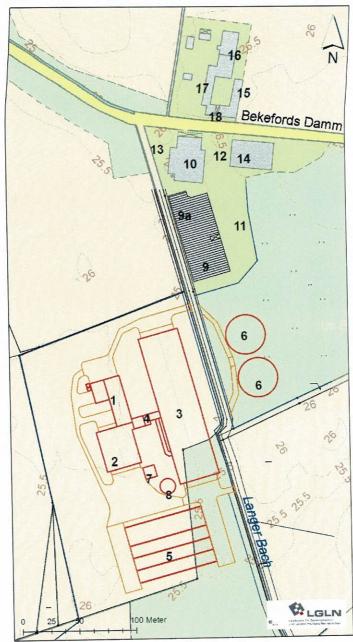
Lageplan des Betriebes Budke im Soll-Zustand.
